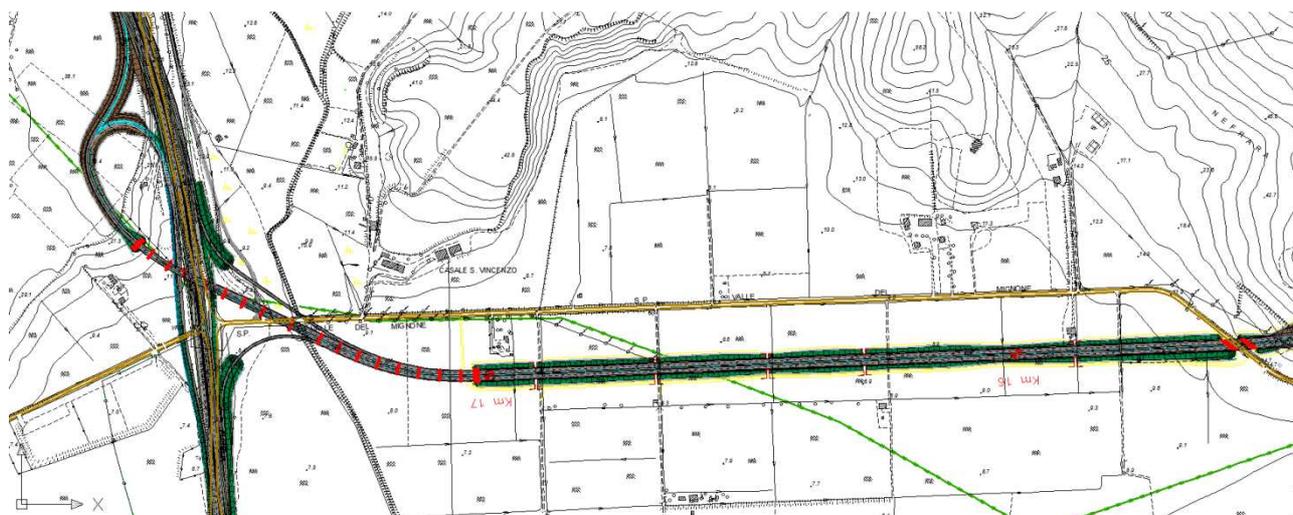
Planimetria di progetto dal km 15+500 in poi
